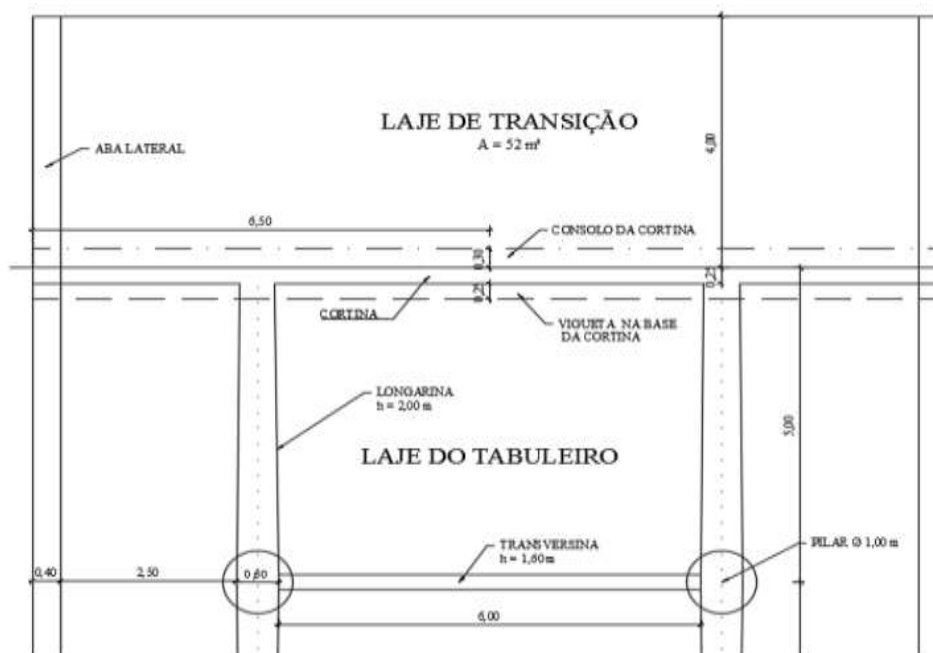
Detalhe da cortina e laje de transição. Fonte: Autor (2018).
